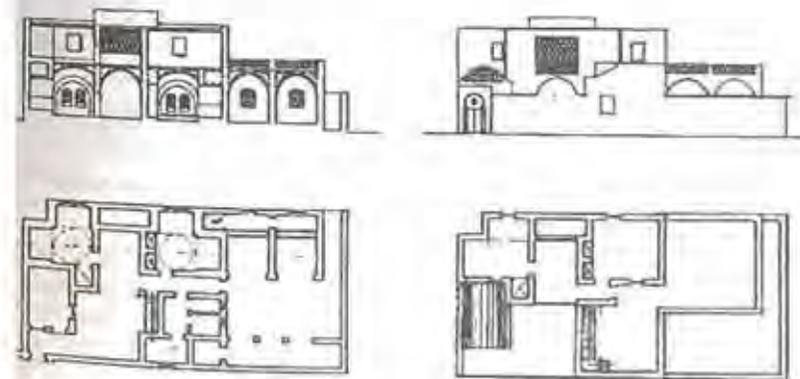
Grundrisse, Schnitt und Fassade des Haustyps in Tunesien
